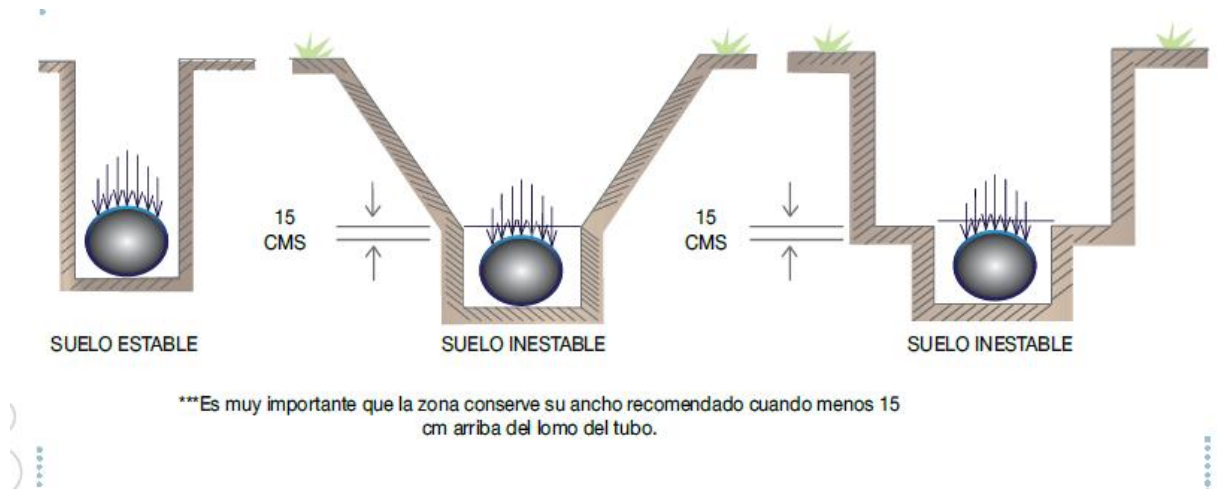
Recomendación para instalar tubería de HDPE.
